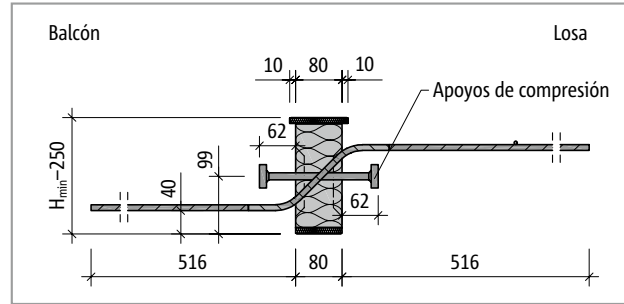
Schöck Isokorb® T tipo Q-P-V4: Sección del producto
